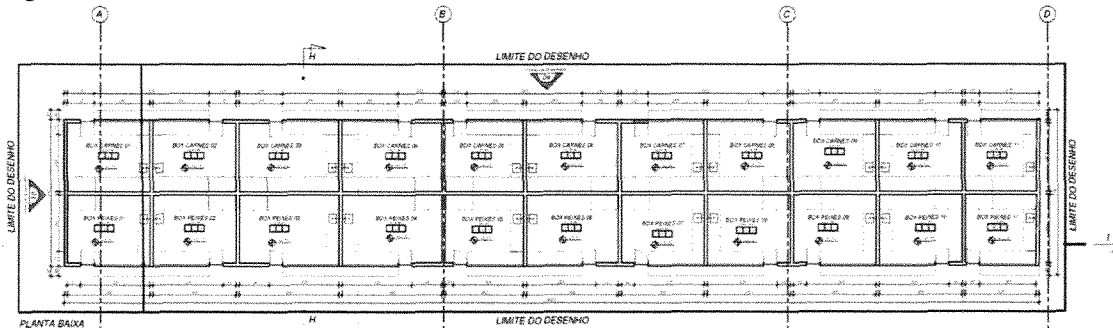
Box de Carnes e Peixes - Planta Baixa
